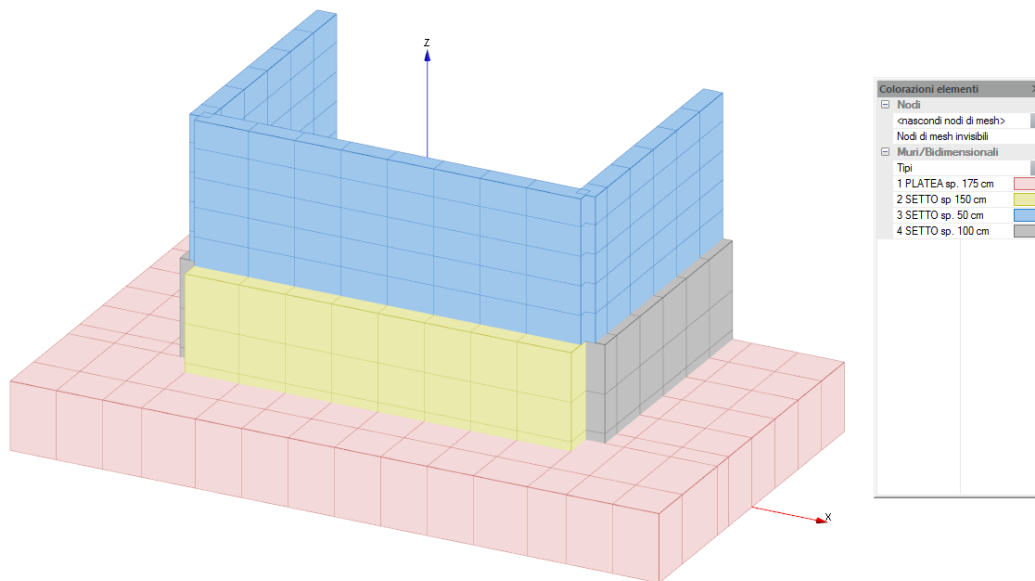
VISTA TRIDIMENSIONALE SOLIDA MODELLO SPALLA 2 – LATO VALLE
